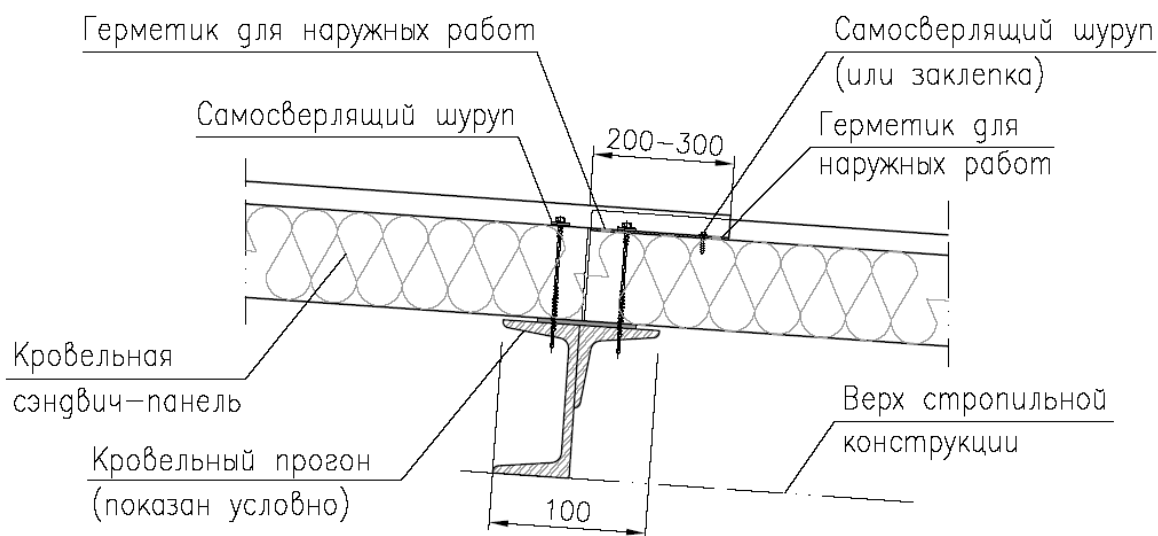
Нахлест кровельных панелей. Окончание монтажа
